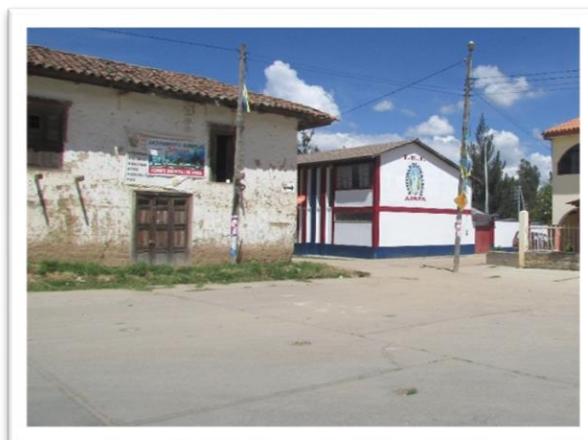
Calle Huancavelica, tramo asfaltado en la Plaza de Armas de Apata
